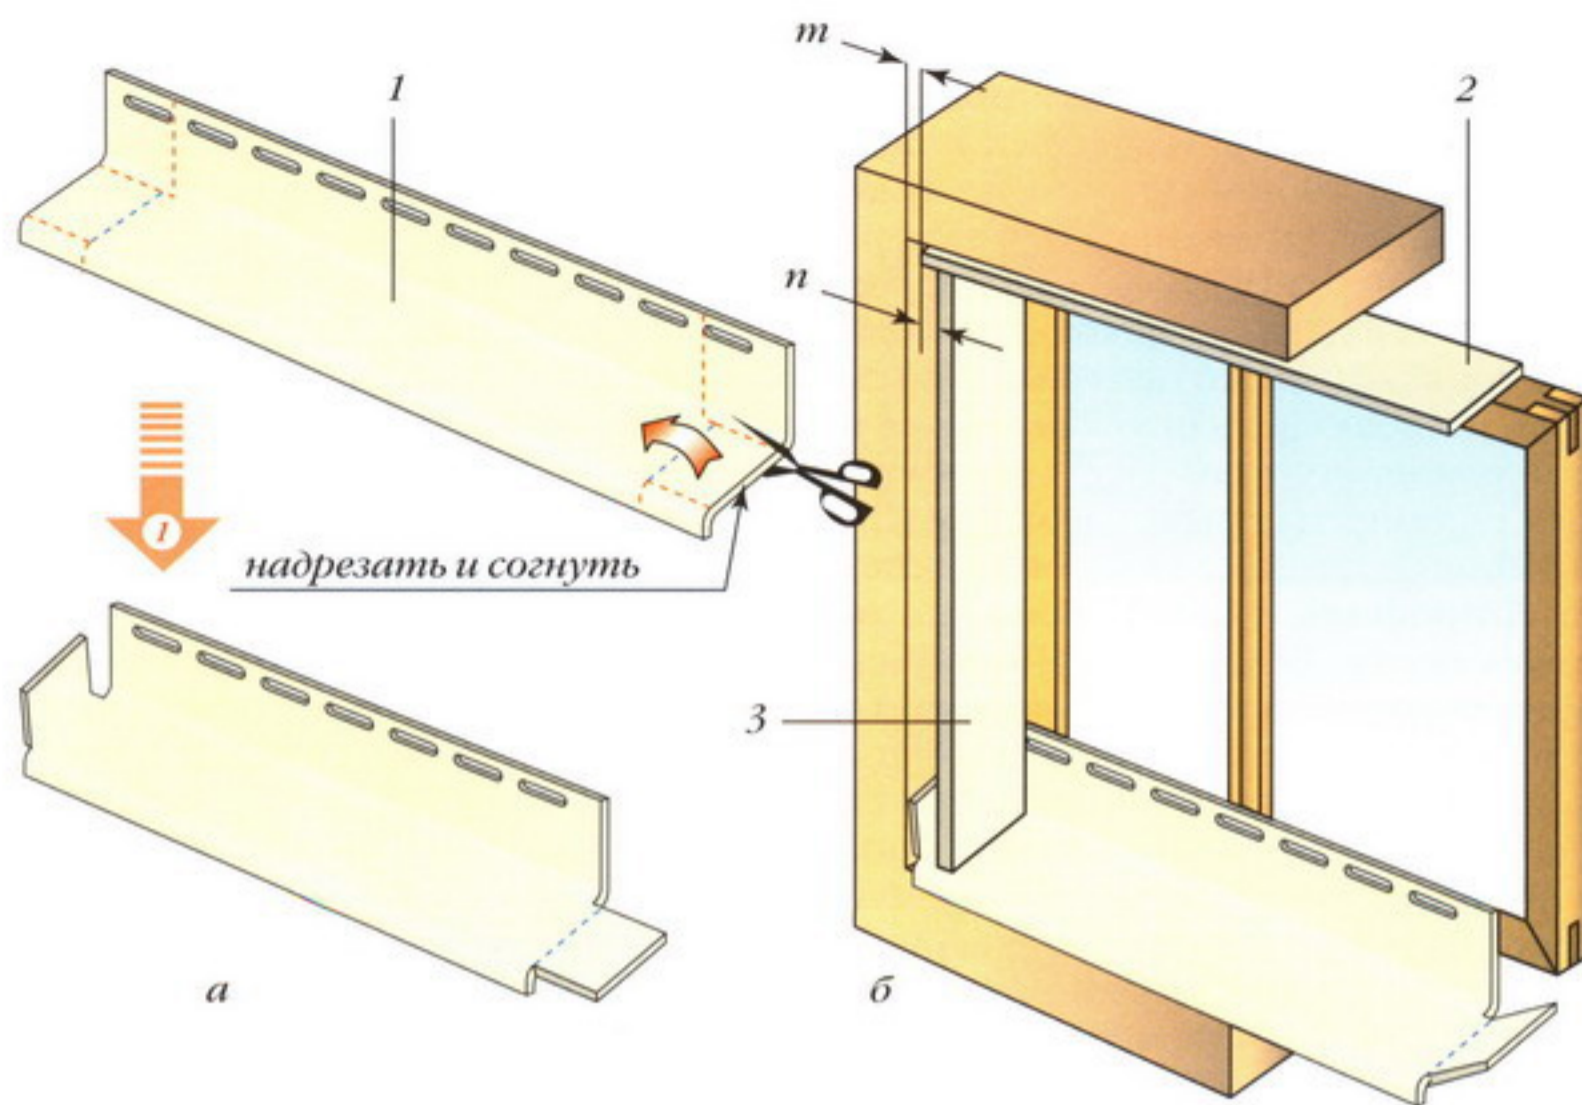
Установка винилового отлива: а — подрезка отлива; б — откосы в сборе; 1 — отлив; 2 — верхний откос; 3 — боковой откос; m, n — не менее температурного зазора
